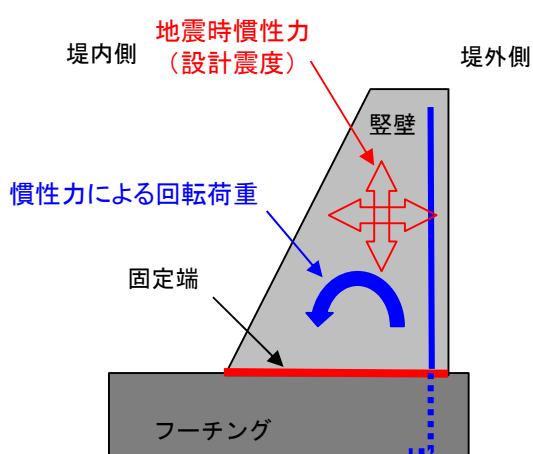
鉄筋コンクリート防潮壁の評価モデル概念図
